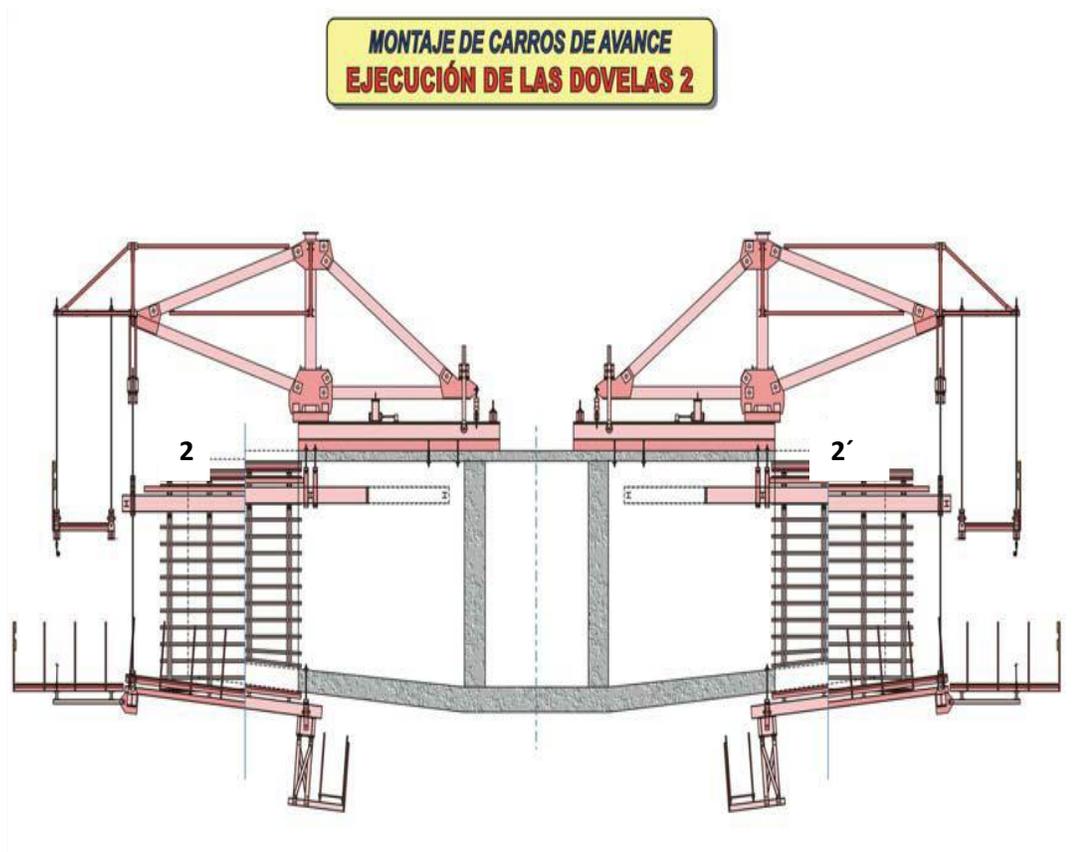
Construcción de las dovelas simétricas 2 y 2'
